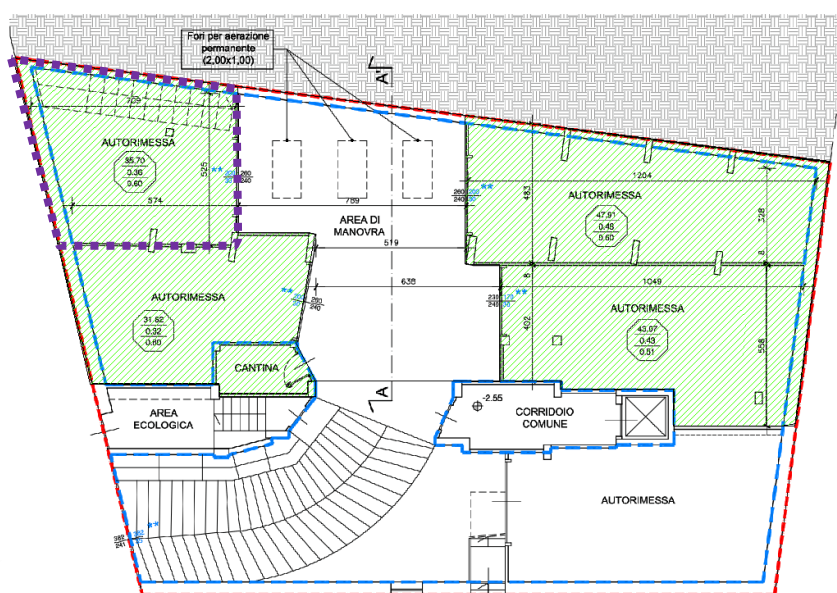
ESTRATTO PLANIMETRIA SCIA DEL 2021 PER COMPLETAMENTO PIANO INTERRATO (INEFFICACE)
